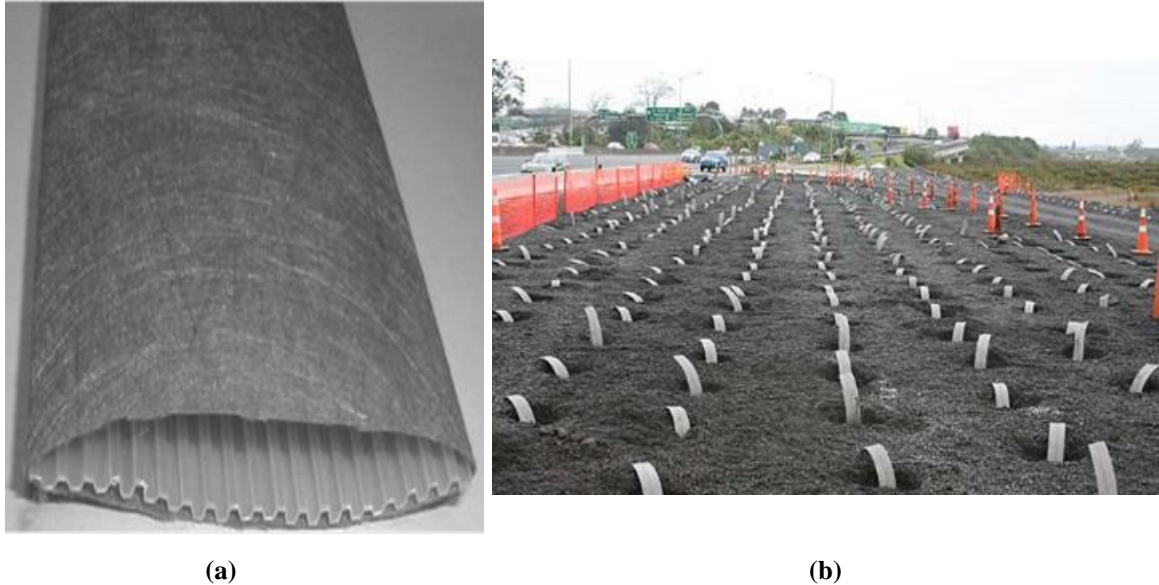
(a) Detalle (Auvinet y Rodríguez, 2002) y (b) construcción de drenes verticales prefabricados (<http://www.stuff.co.nz/auckland/local-news/western-leader/9522556/Wick-thinking-underpins-motorway-sea-water-drainage-process>).
